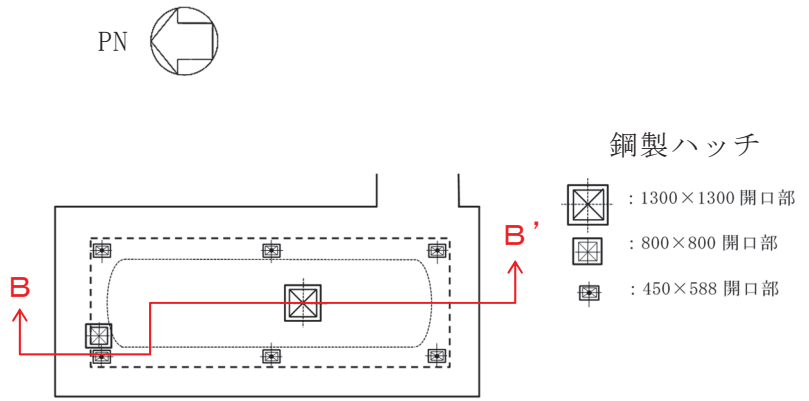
軽油タンク室 (H) の概略平面図 (O.P. 14.80m)
